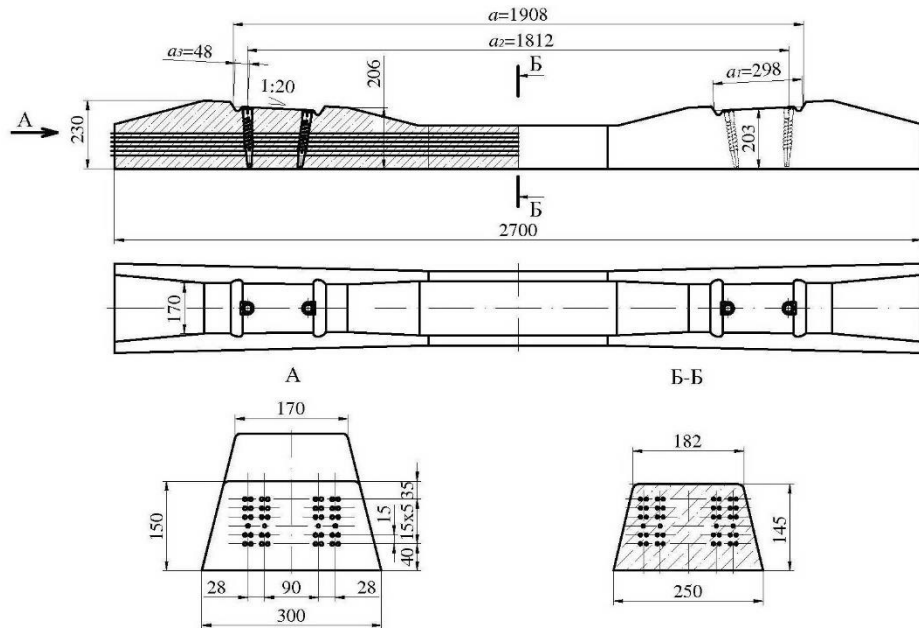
Шпала залізобетонна попередньо напружена типу SH.1.
